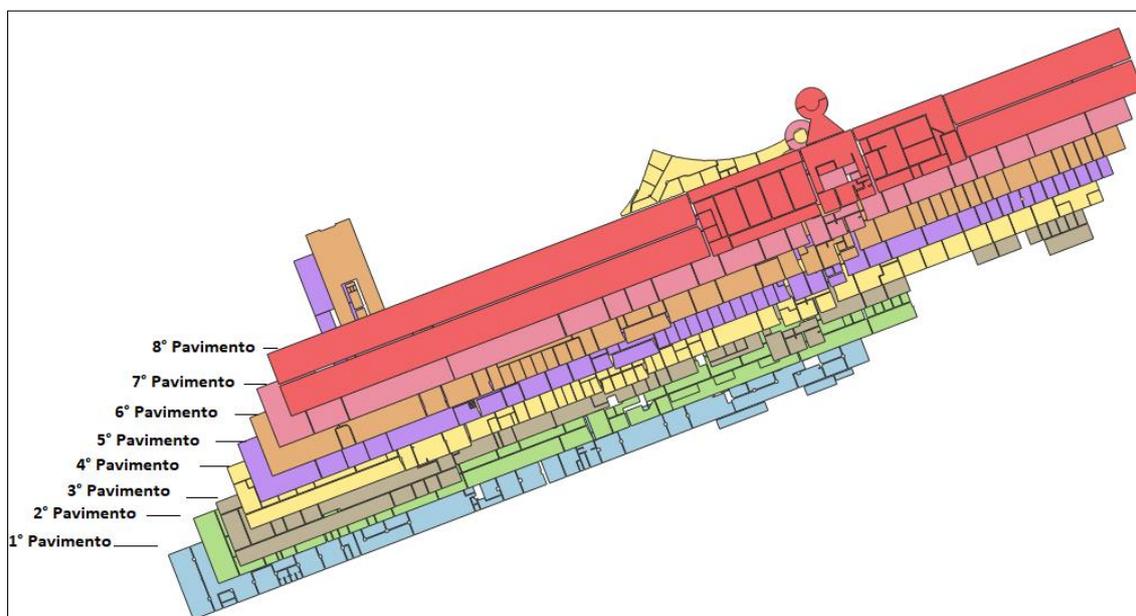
Disposição dos pavimentos. Fonte: Autor, 2021.
